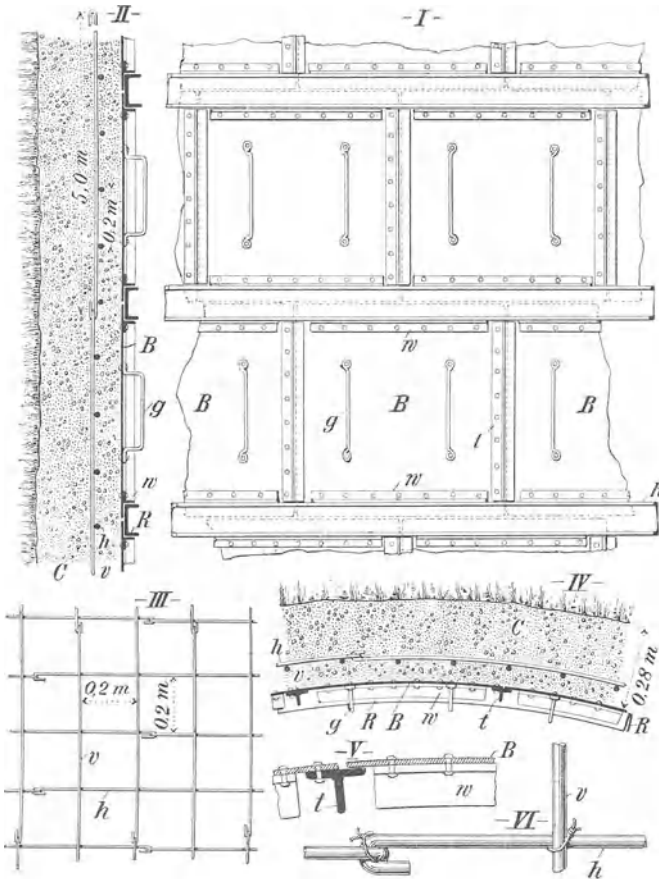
Schachtausbau mit Eisenbeton unter Verwendung eines Lehrgerüsts.
